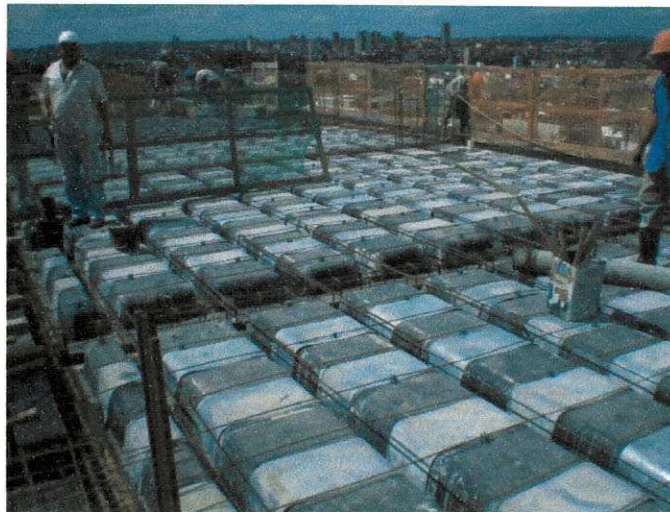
Detalhe da laje armada em uma direção. Armaduras longitudinais positivas e negativas.
